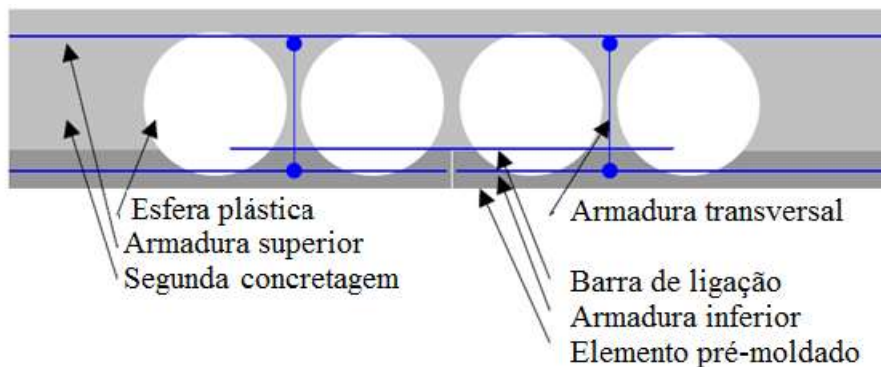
Esboço principal da laje *BubbleDeck* (SILVA, 2016)
